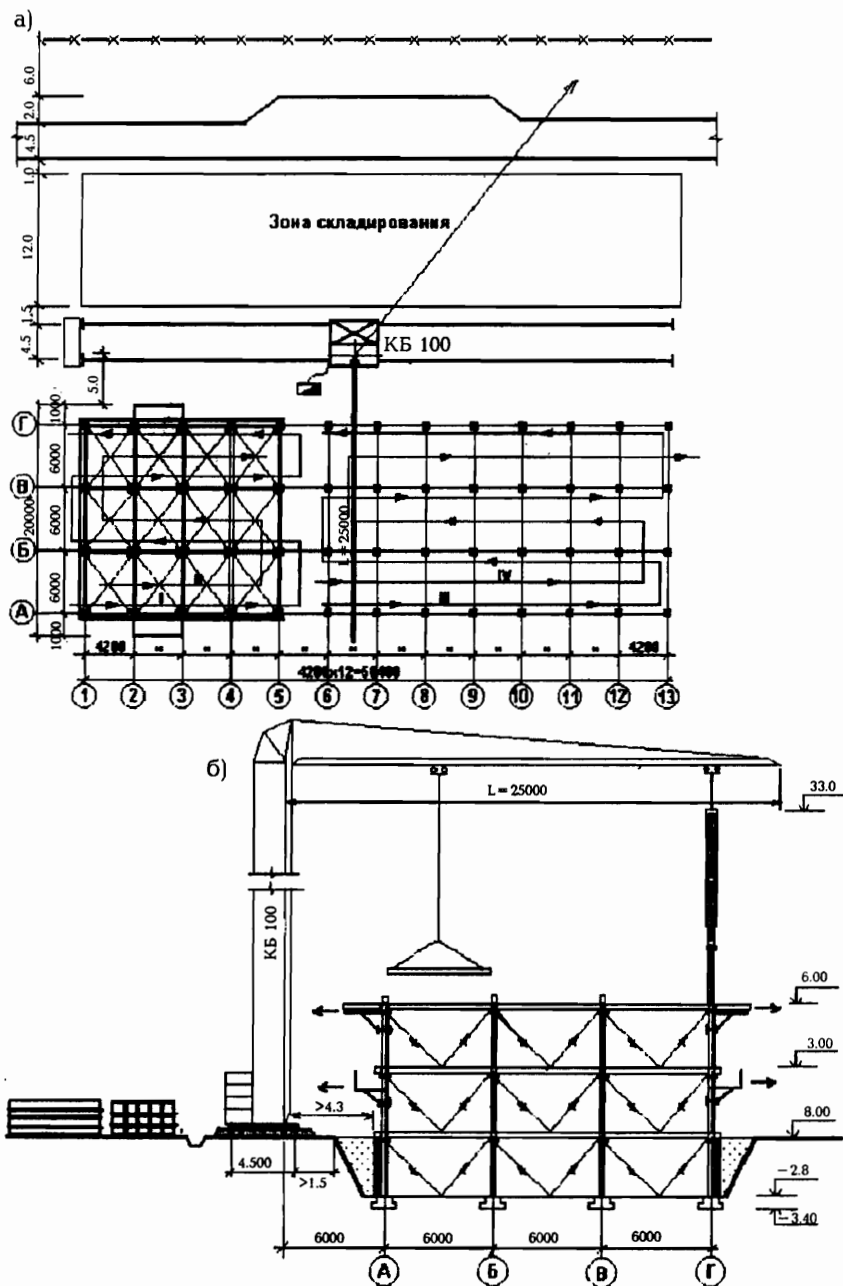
Технологические схемы и последовательность монтажа элементов безбалочного каркаса: а – фрагмент стройгенплана; б – поперечный разрез на период монтажа элементов каркаса
